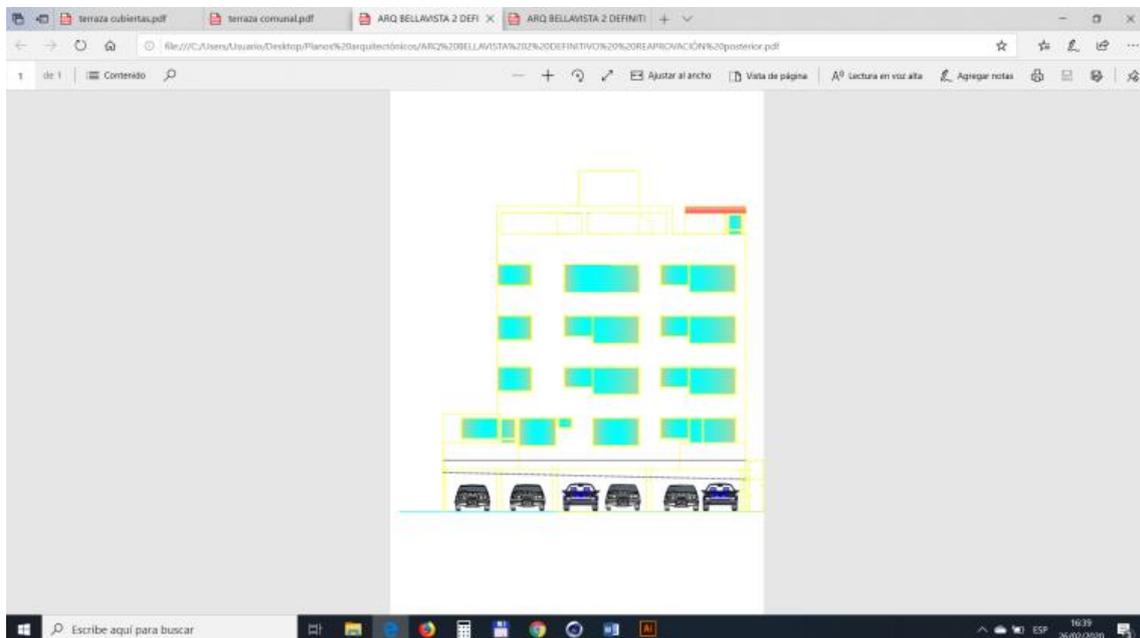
Pdf de los planos de la fachada posterior del edificio, 2020
